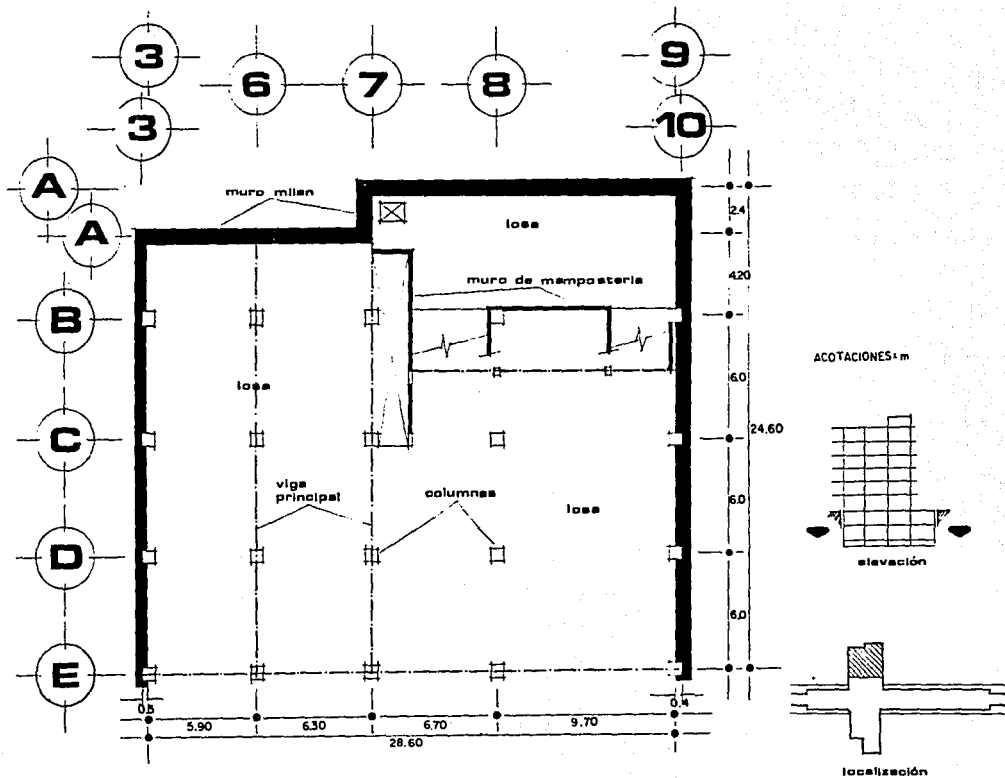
PLANTA DEL NIVEL MEZZANINE
